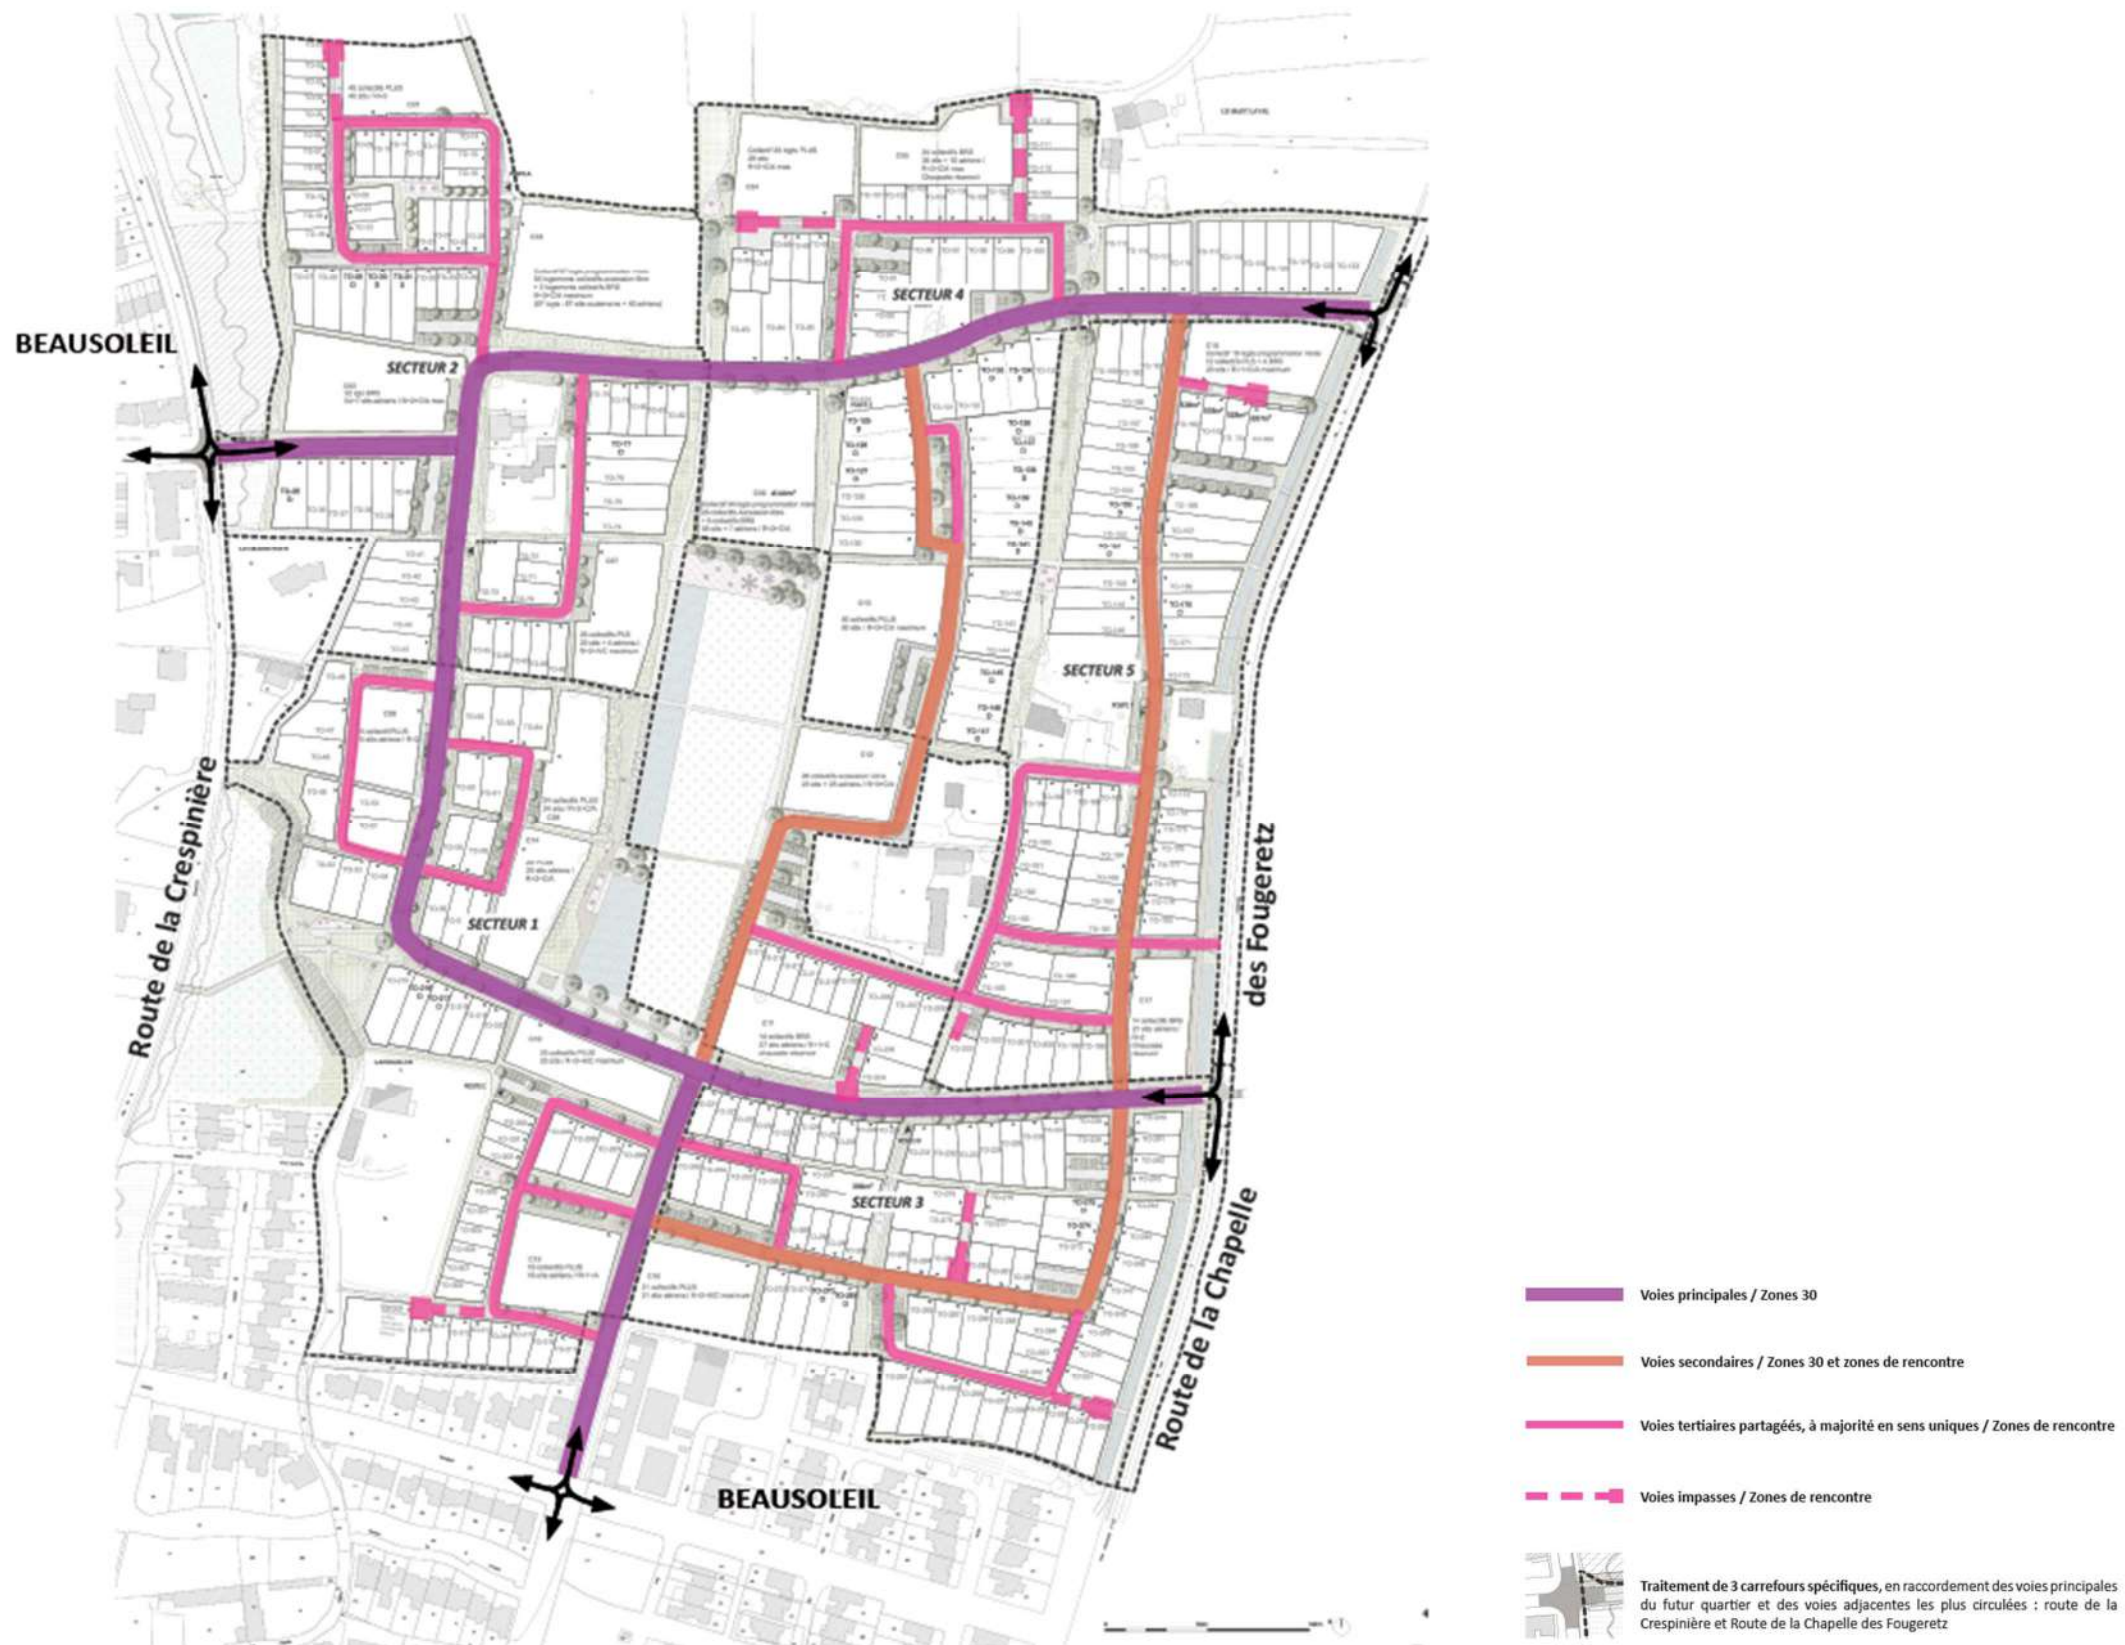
plan des liaisons viaires du secteur Touraudière – stade AVP
